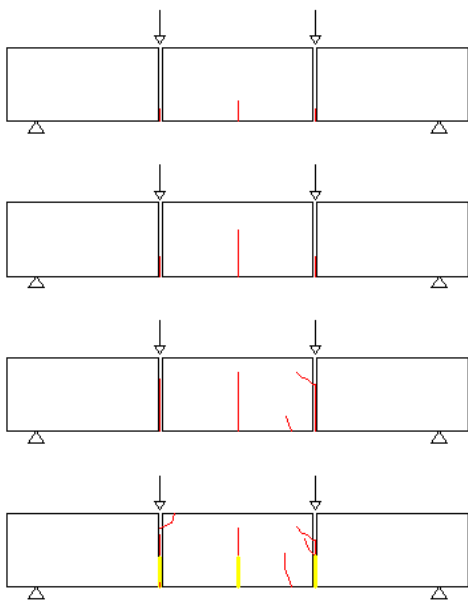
Mapeamento das fissuras VCE-1.
